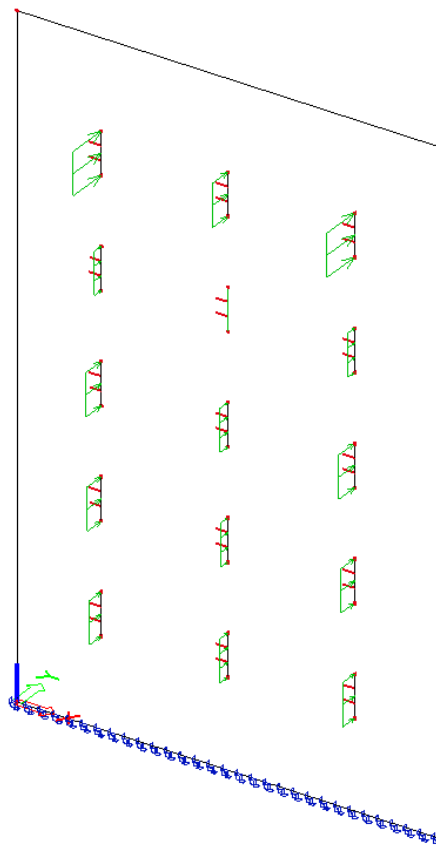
Verdeling van de trekkracht voorgesteld door lijnlasten
